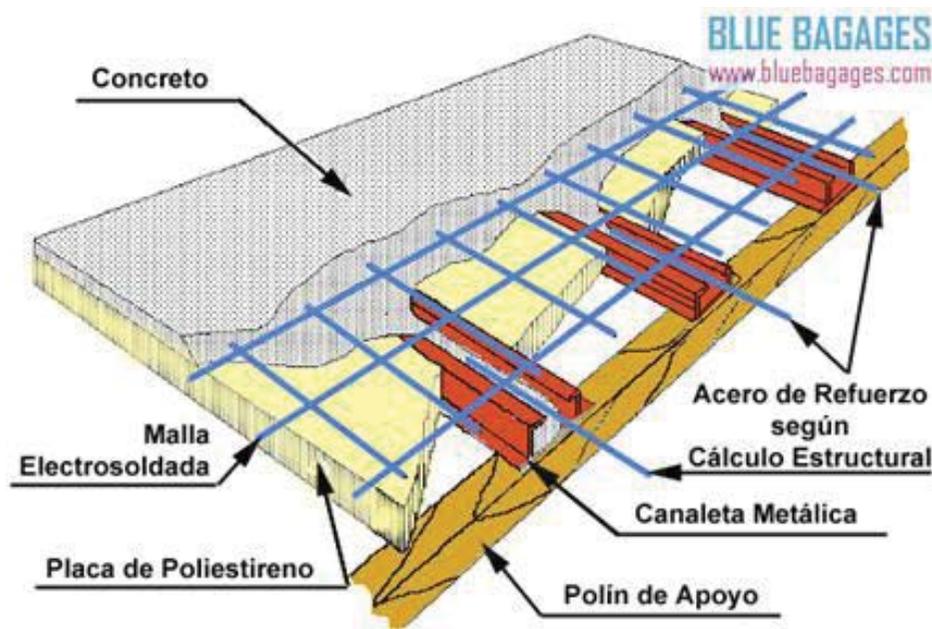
Ejemplo de estructura de concreto tipo panel unido con perfiles metálicos.
